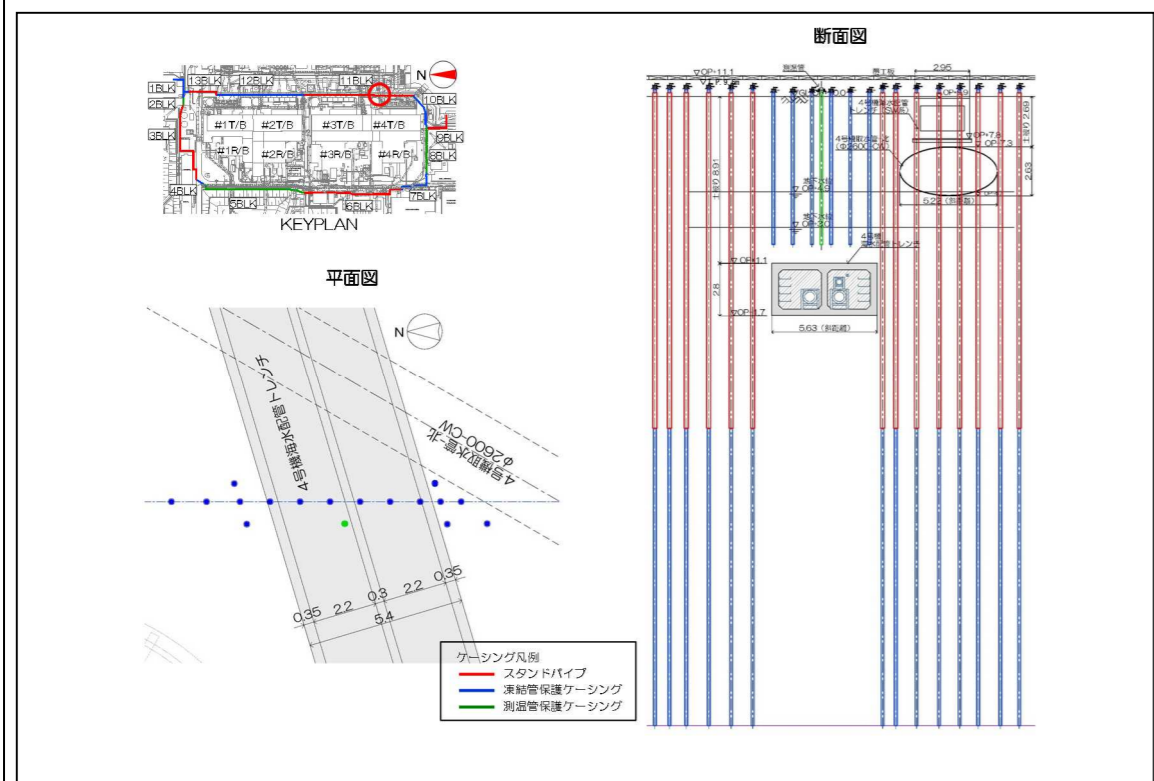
4号機海水配管トレンチ部 施工平面図・断面図
